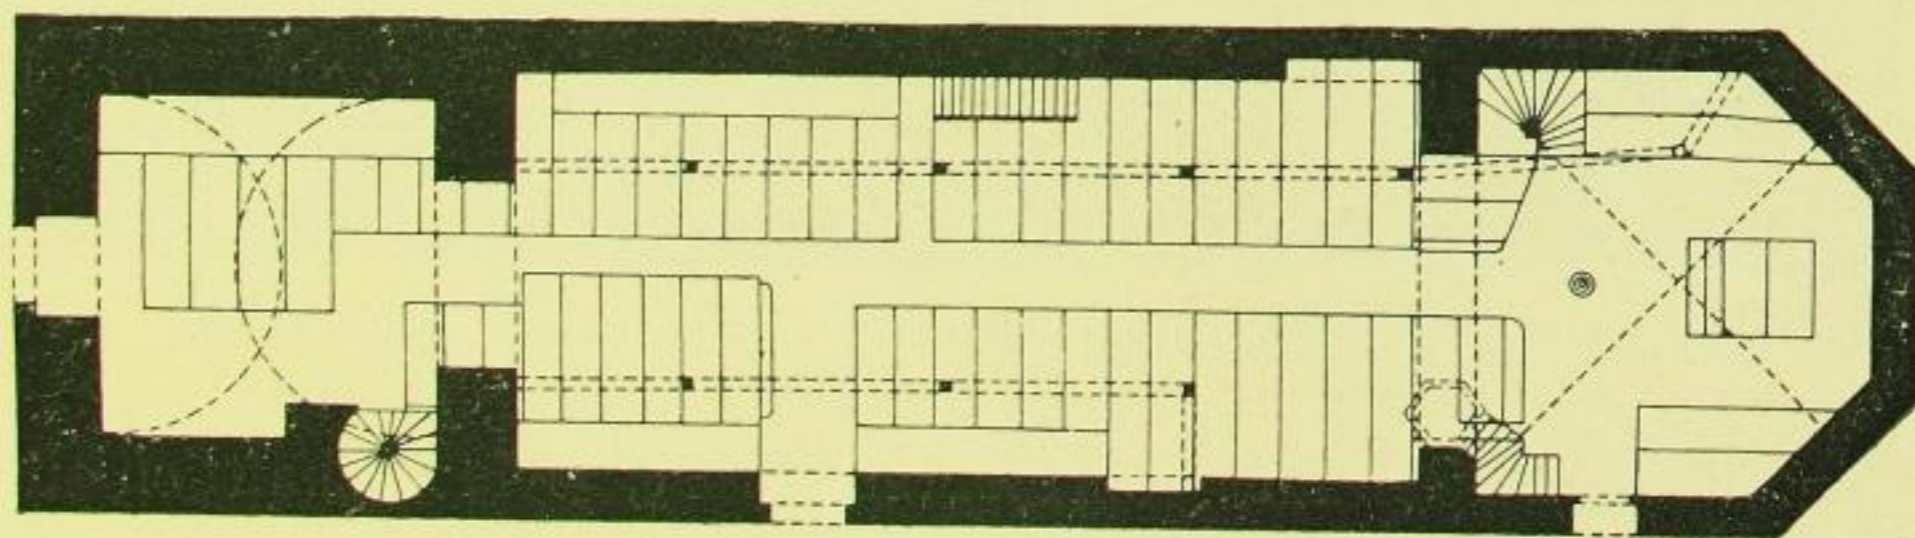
Weinböhla, alte Kirche, Grundriß.
